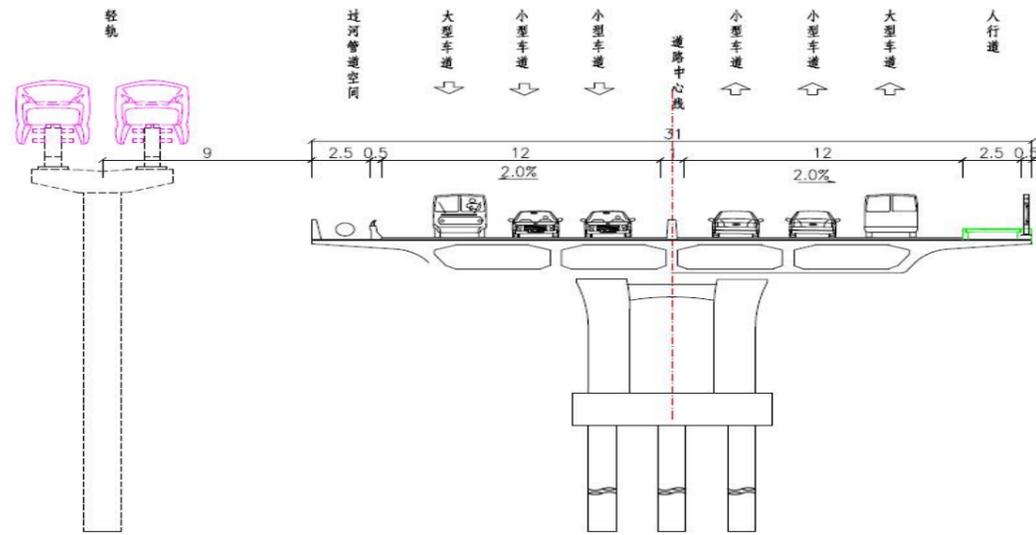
跨大港河、西港河桥梁横断面图（尺寸单位：m）
